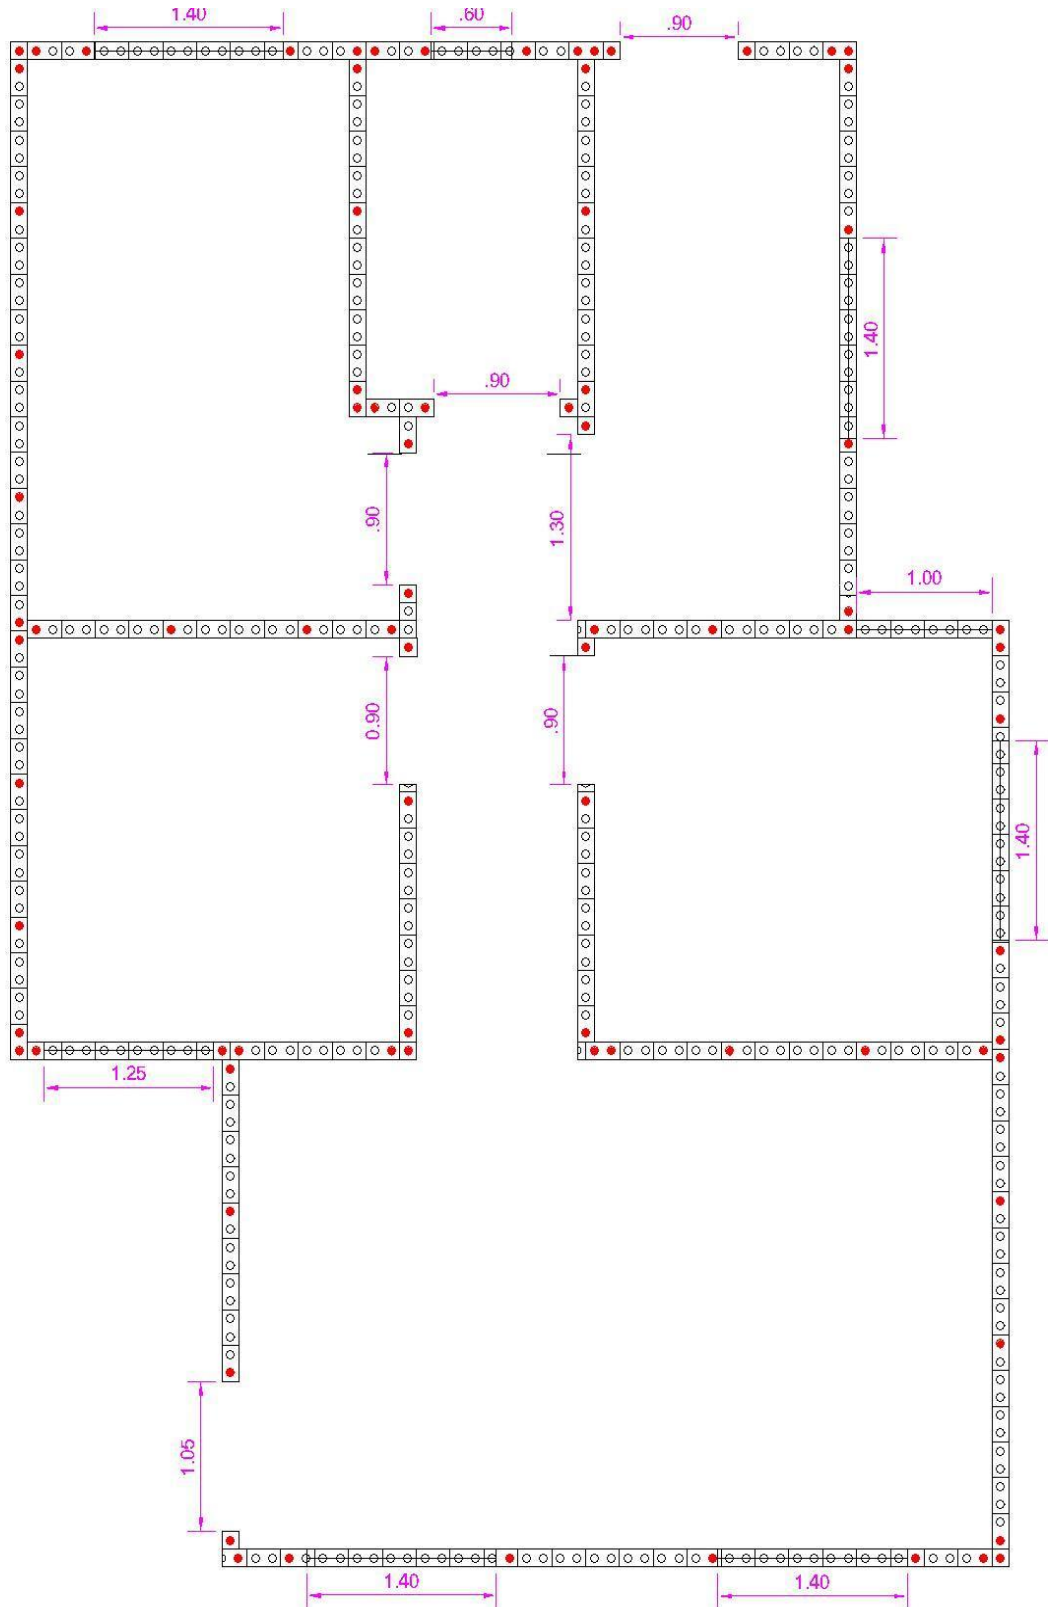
Planta de Localização dos Grautes, Portas e Janelas
